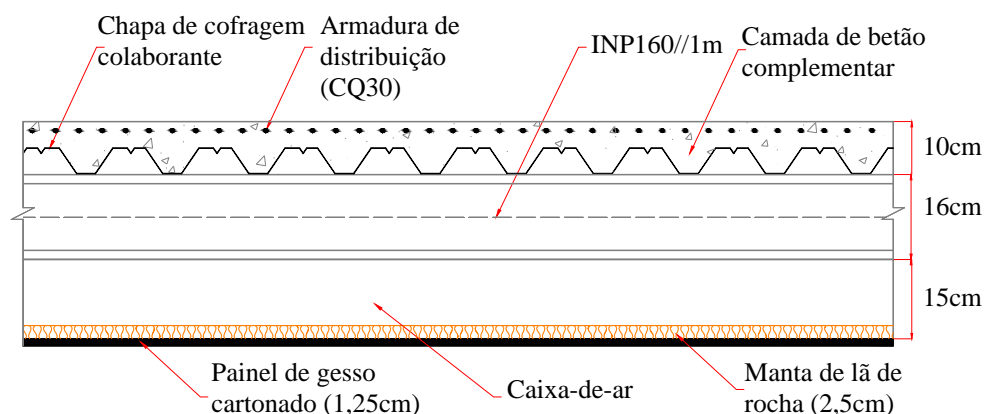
Pavimento misto de cofragem metálica colaborante com tecto falso e isolante térmico (Pav11)
